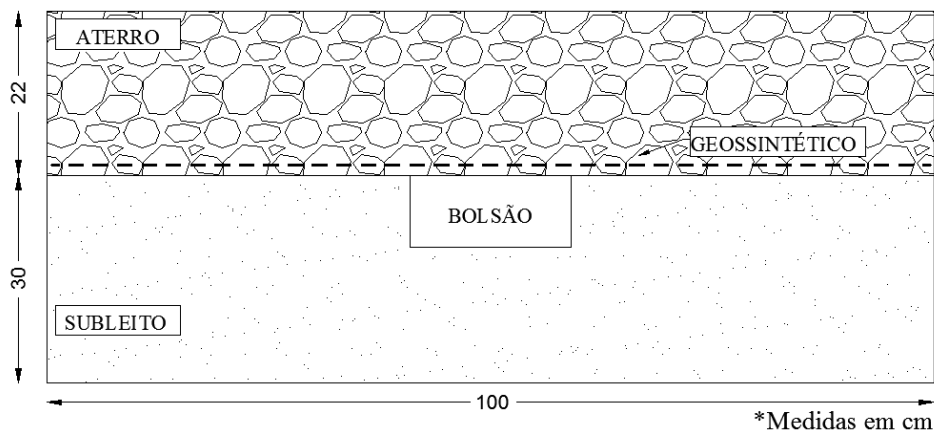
Perfil transversal da estrada não pavimentada estudada.
